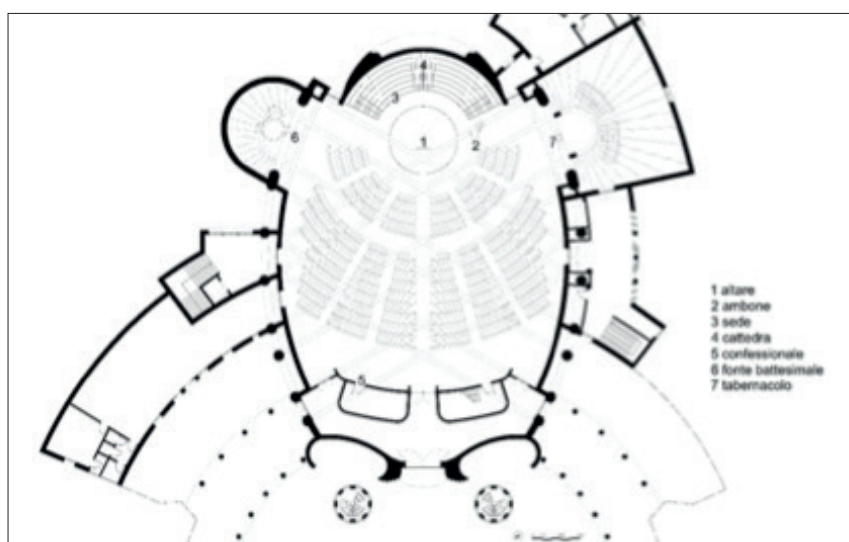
planimetria della chiesa di San Benedetto di Lamezia Terme (VV)
